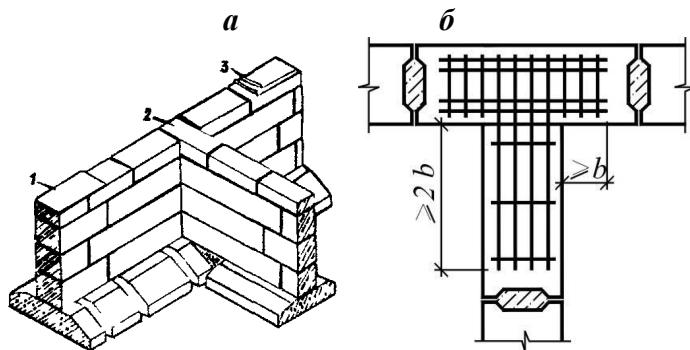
Перевязка блоков продольных и поперечных стен подвала: *a* – перевязка блоков; *б* – усиление примыкания арматурными сетками; 1 – выровненная поверхность стены подвала; 2 – перевязка блоков; 3 – гидроизоляция.
